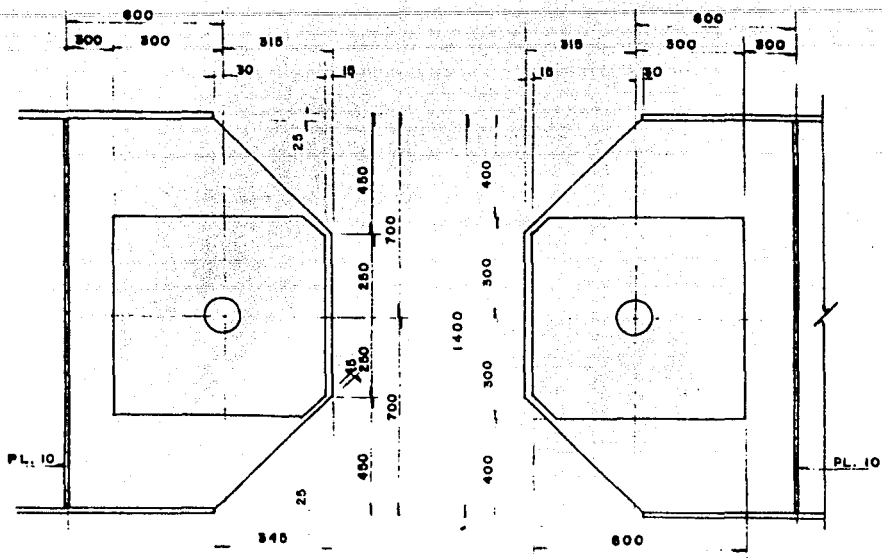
ARTICULACIONES QUE DIVIDEN LA ZONA CONVENCIONAL DE LA ZONA ATIRANTADA.
